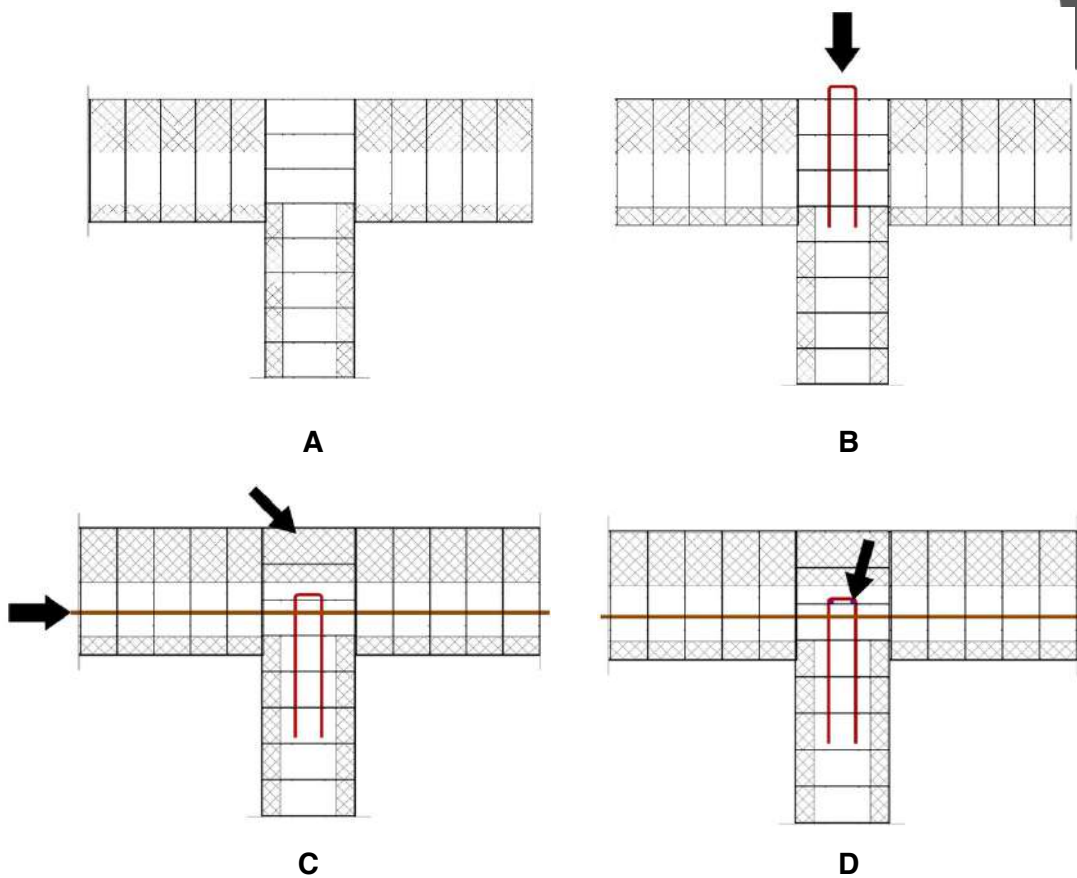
Secuencia de instalación de refuerzos en unión de muro en T
